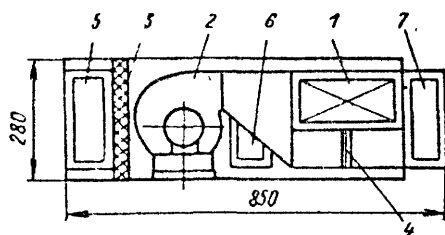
Квартирный отопительно-вентиляционный агрегат
